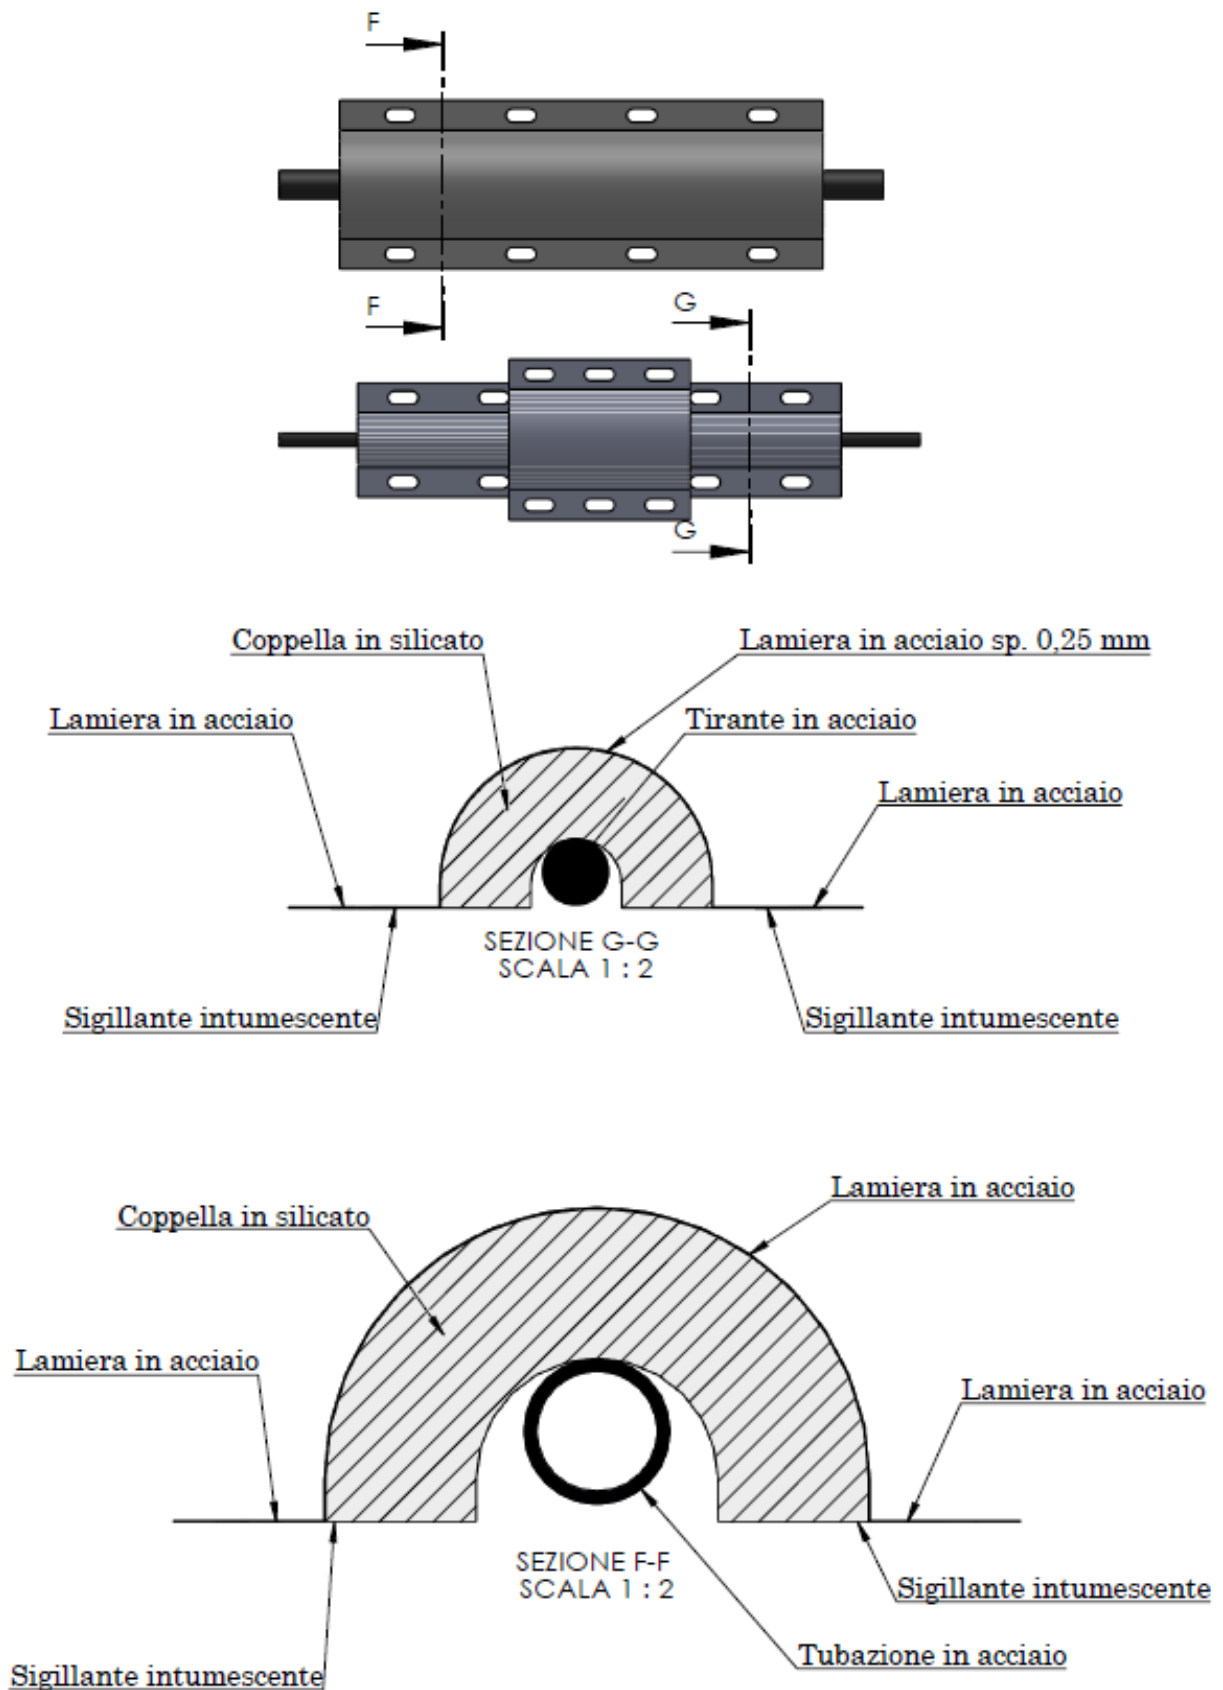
Schema sezione tipo coppelle a parete o soffitto
